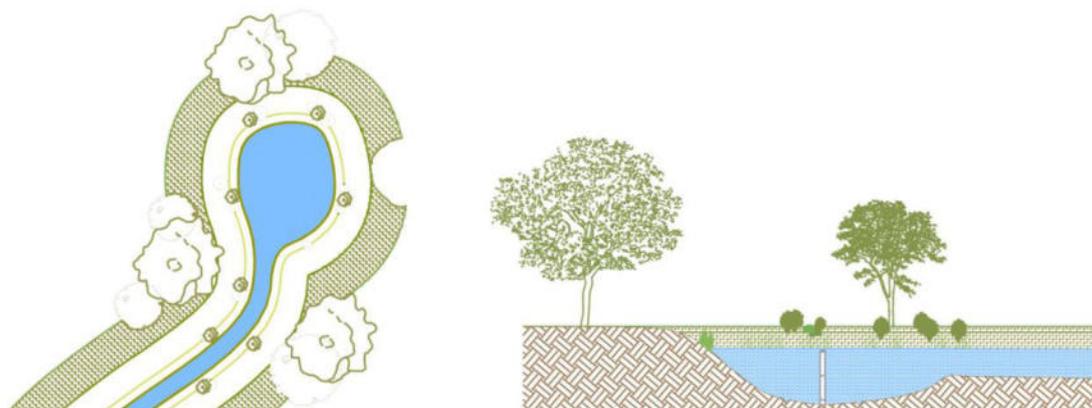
Planimetria e sezione di un intervento tipo: recupero e riqualificazione di una testa di fontanile.
